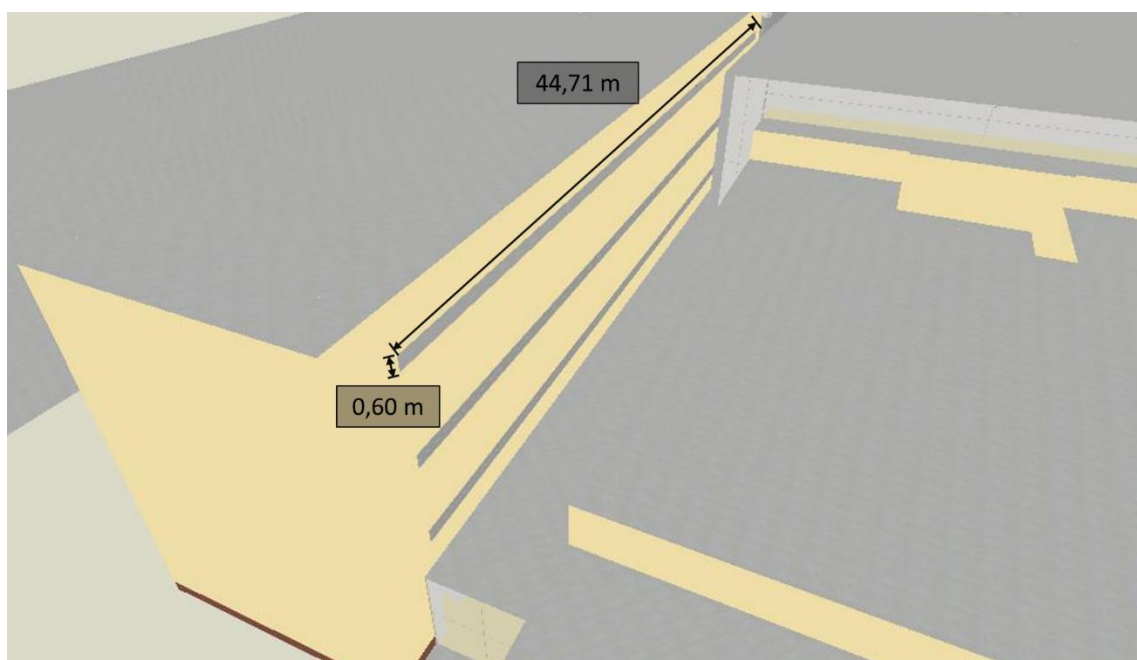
Dimensões dos Vãos Envidraçados da Fachada NO do Longo Bloco com Gabinetes
